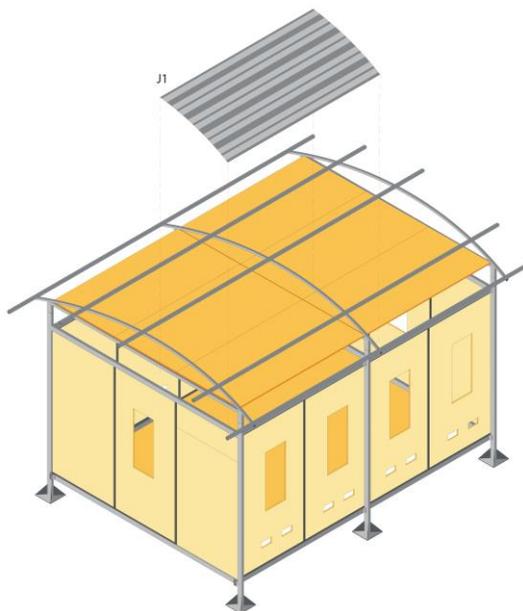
Colocación de láminas de zinc sobre estructura de cubierta.
